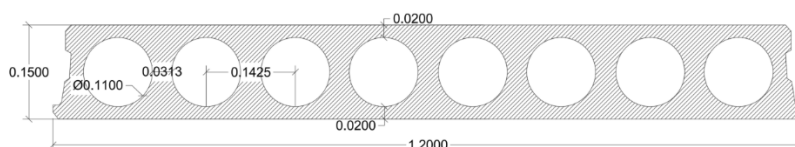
Secção transversal do painel de laje alveolar P150
